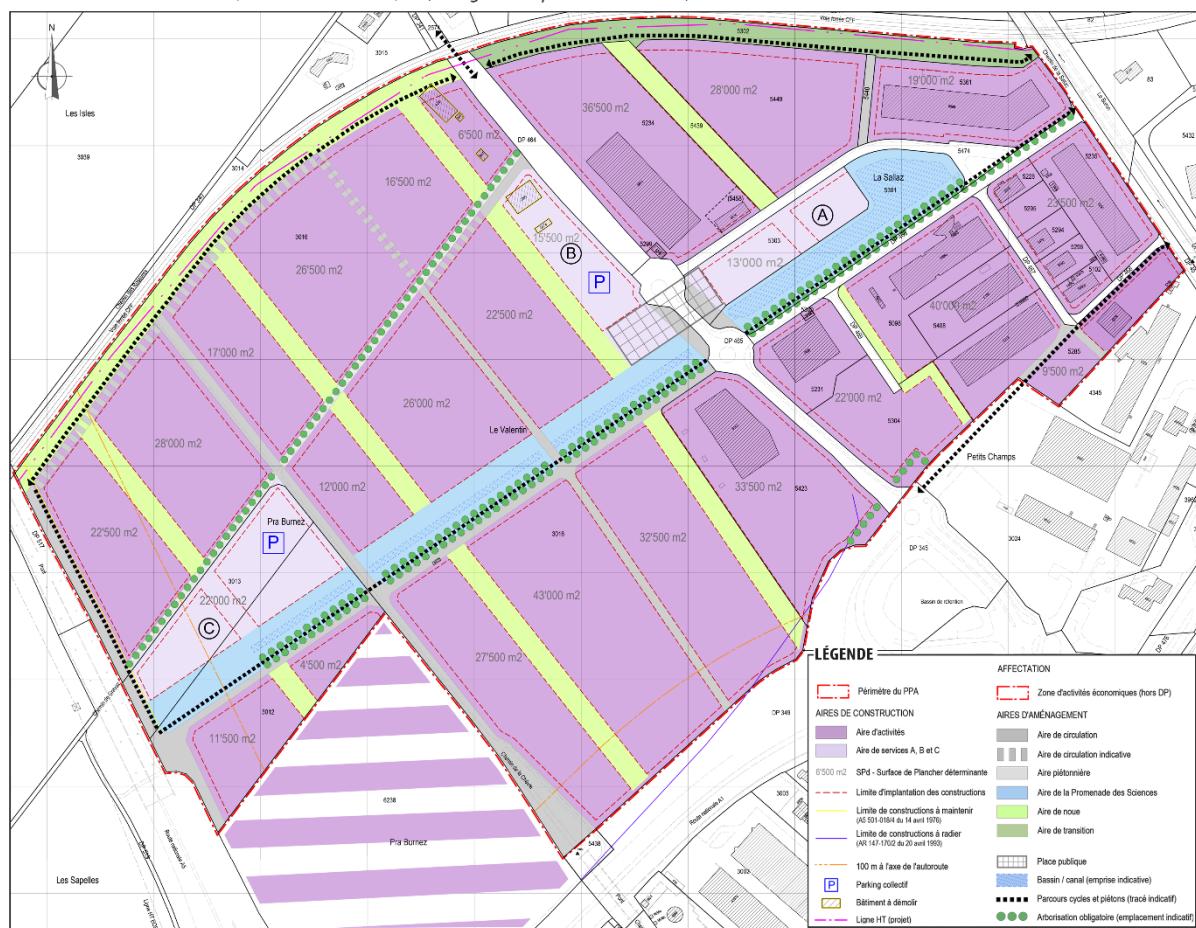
Plan du PPA en vigueur depuis le 30.10.2014 avec illustration d'une éventuelle extension de la zone constructive (hachures)
